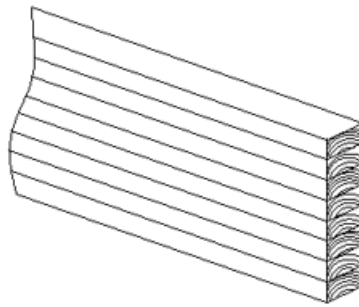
Фрагмент клеєної з дошок двосхилої балки
